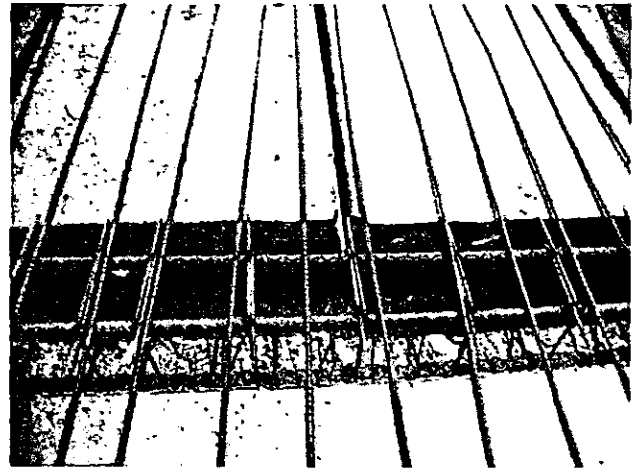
Acero de refuerzo en el firme de compresión en losas extruidas.
